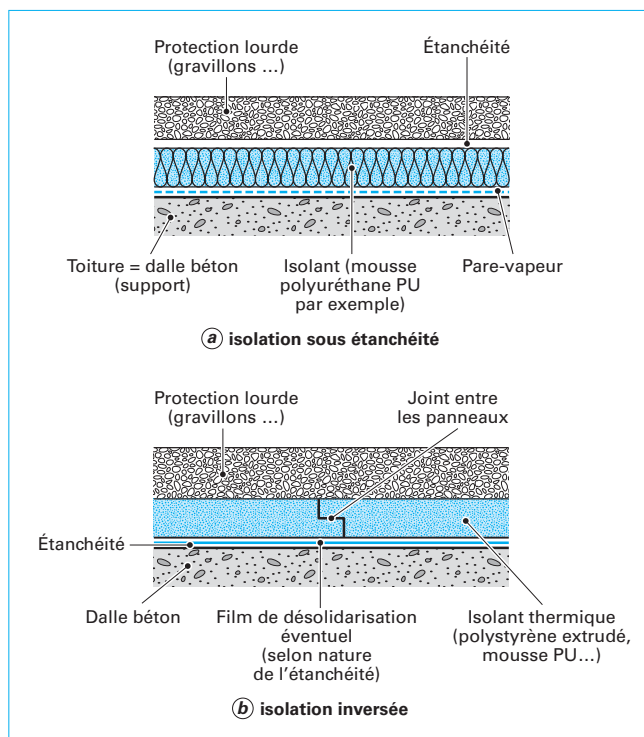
Différents systèmes d'isolation et d'étanchéité de toitures
